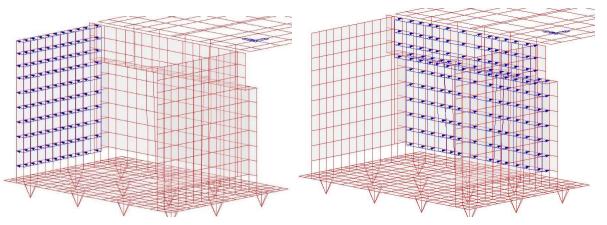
Sovraspinte sismiche applicate alla Spalla A: SLVY+ (sx) e SLVX+(dx)
